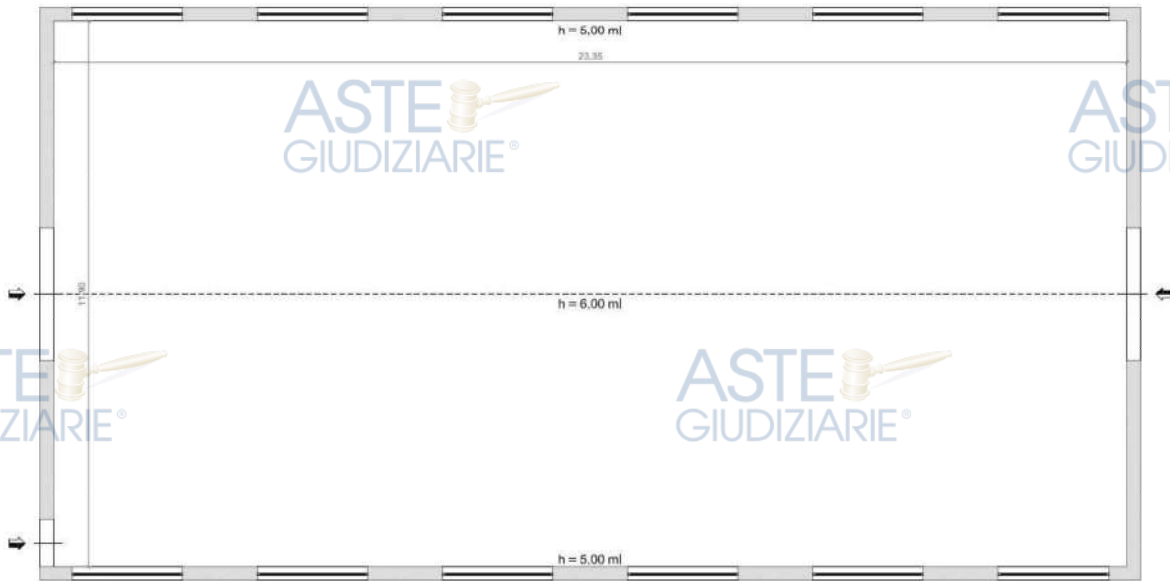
Planimetria Stato di Fatto Capannone, P.lla 403.
